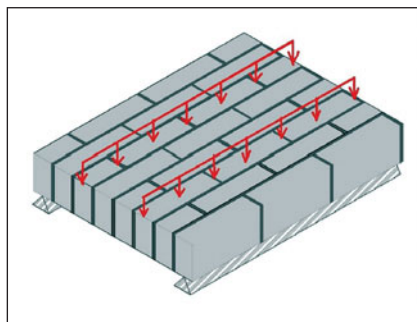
Схема испытаний облицовочного слоя кладки на изгиб
